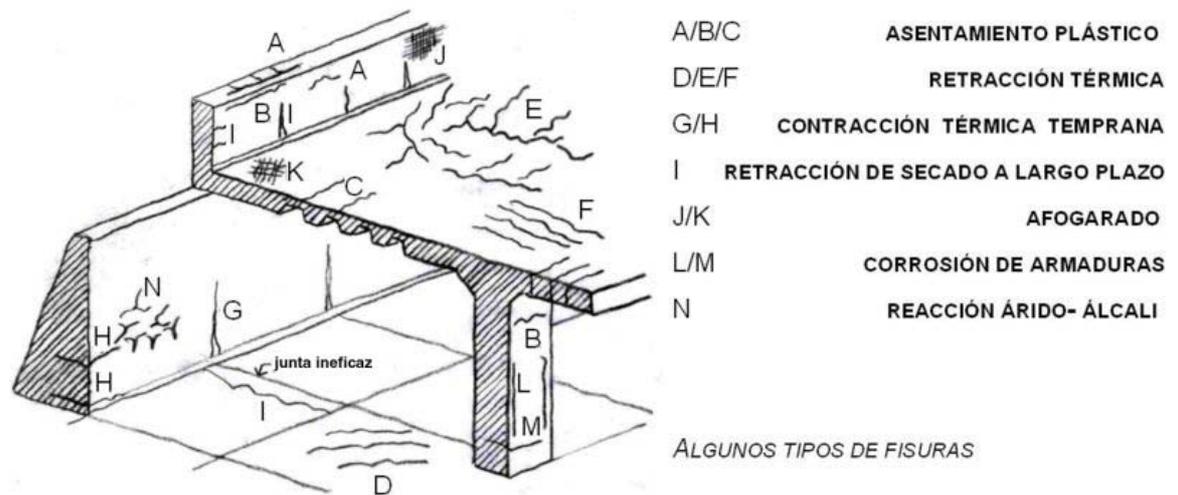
Tipos de Fisuras en el Hormigón.
